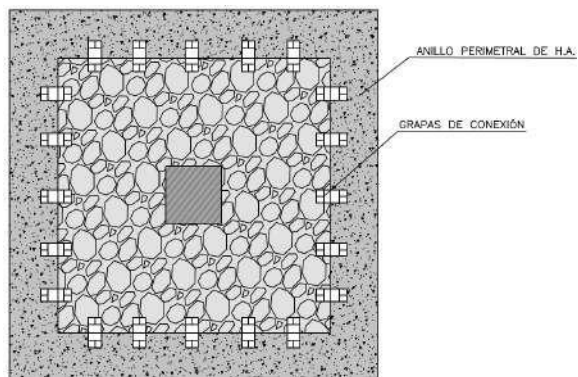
Planta de zapata aislada reforzada. Fuente propia
